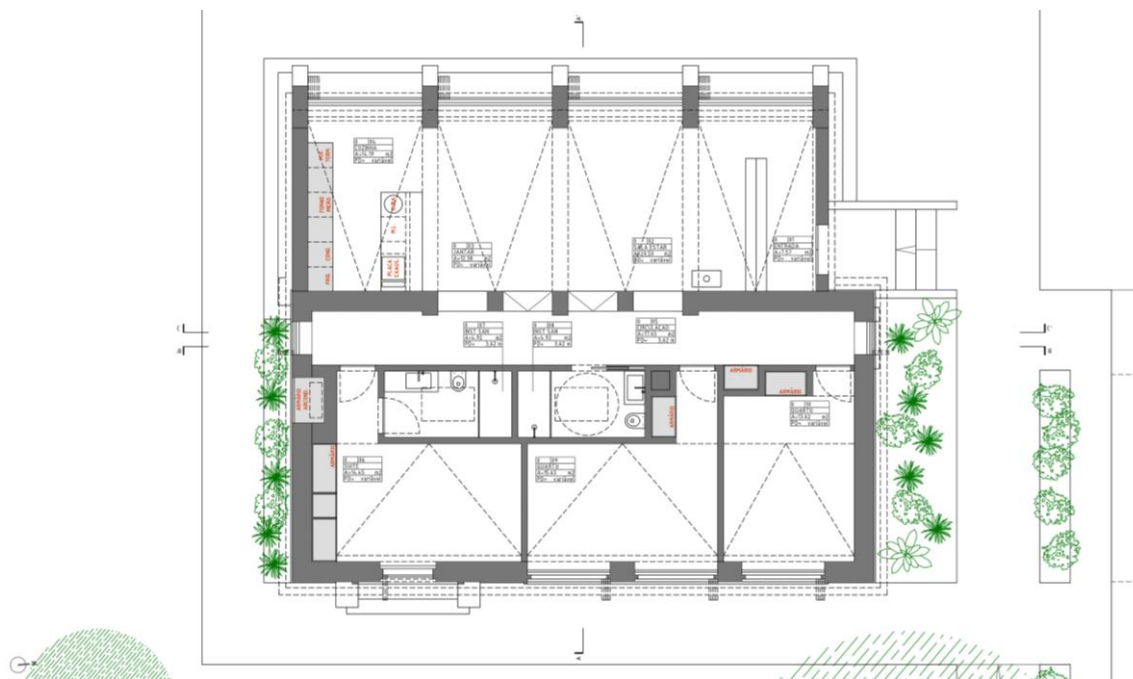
| Planta Piso Térreo (Proposto), Malarranha Grande, Quinta da Malarranha, Arq. João Gomes, 2021
